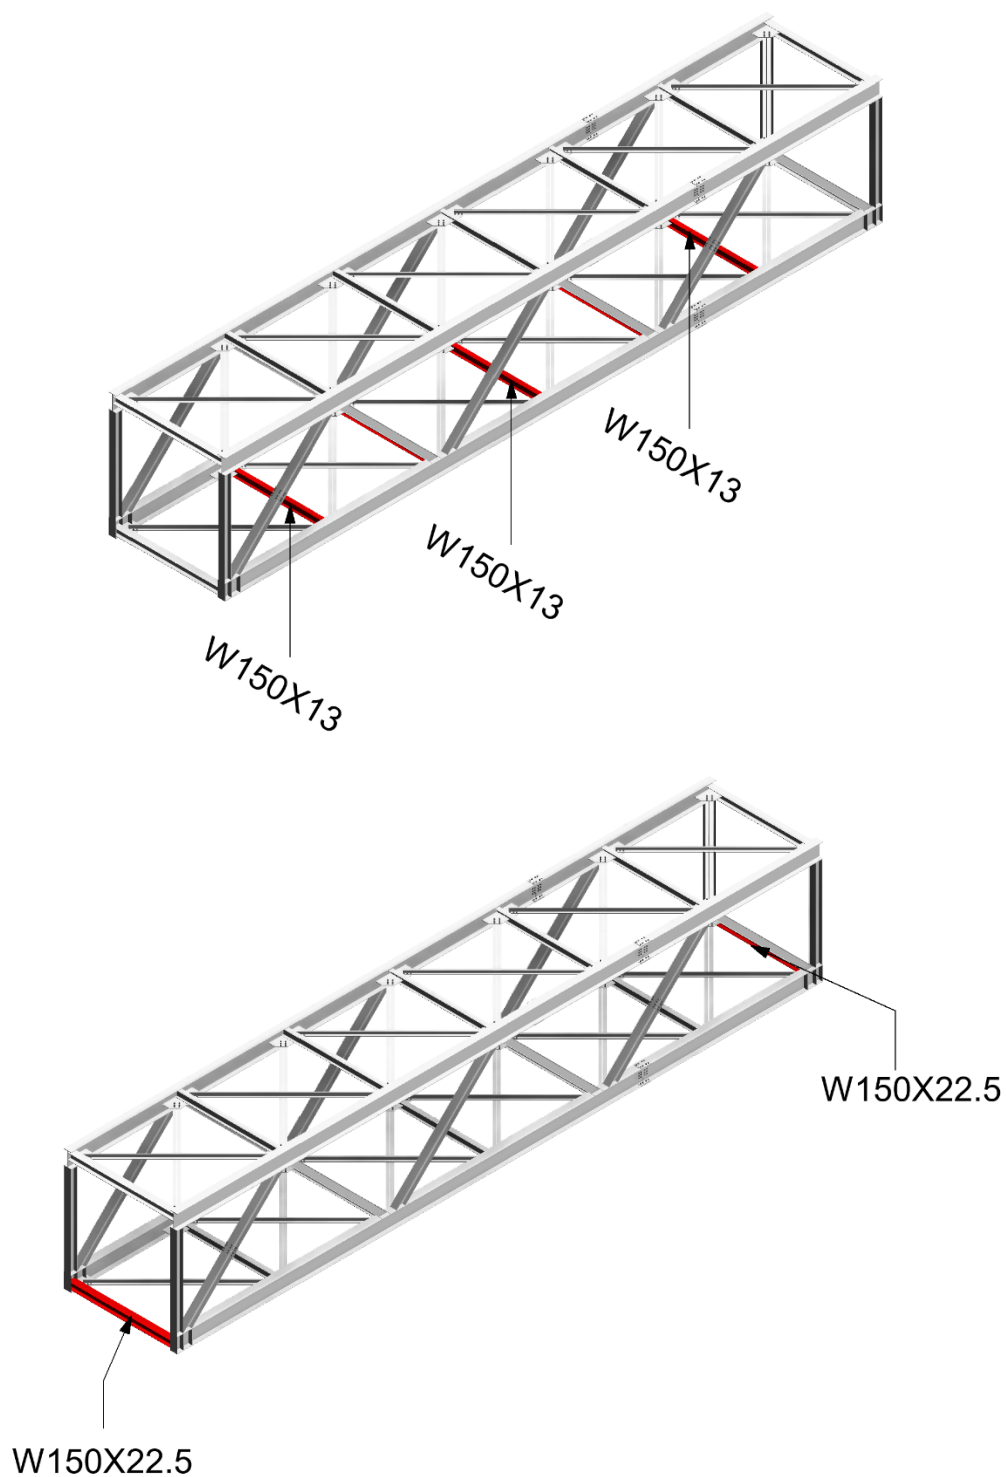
Apoio do Steeldeck do Modelo III.
